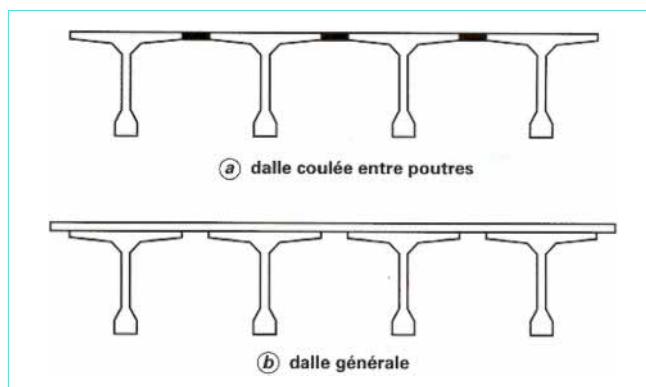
Conceptions possibles d'un tablier de pont à poutres précontraintes
